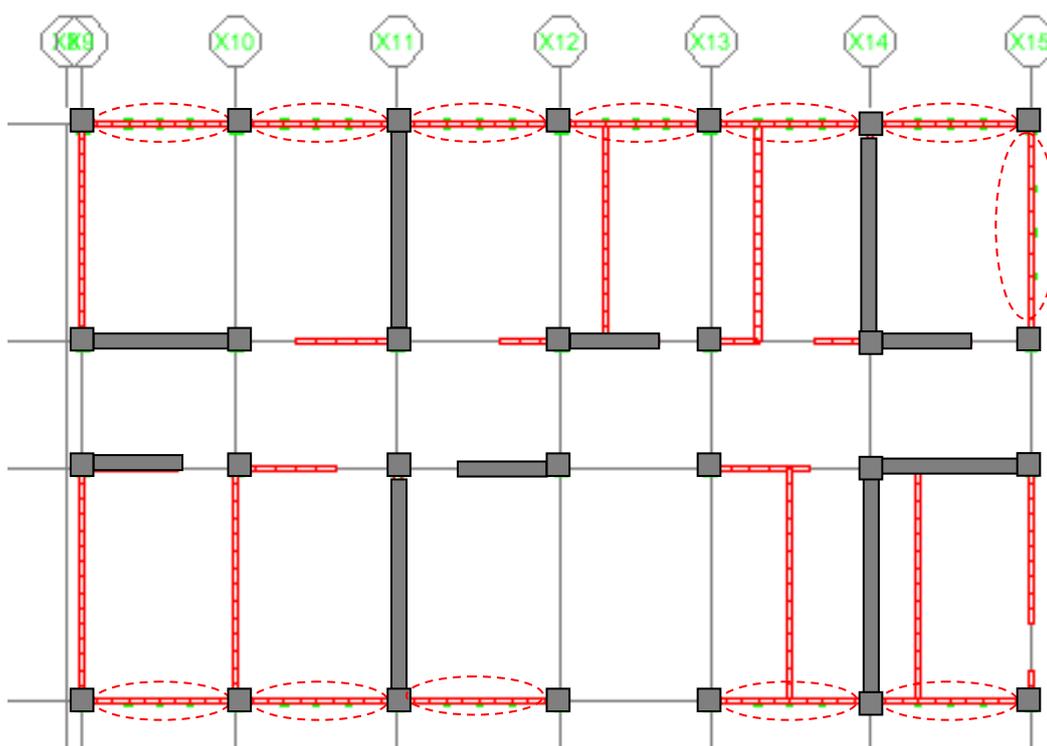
Esquema de reforzamiento con placas de concreto armado en el Bloque 9C
